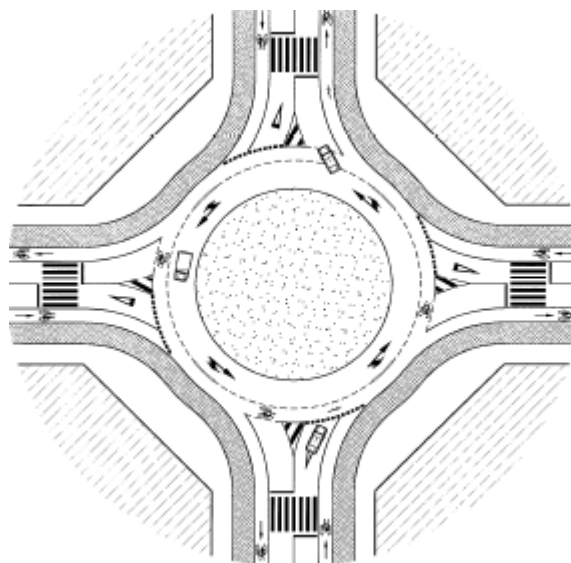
Glorieta con carril bici exterior Fuente: DGT.
